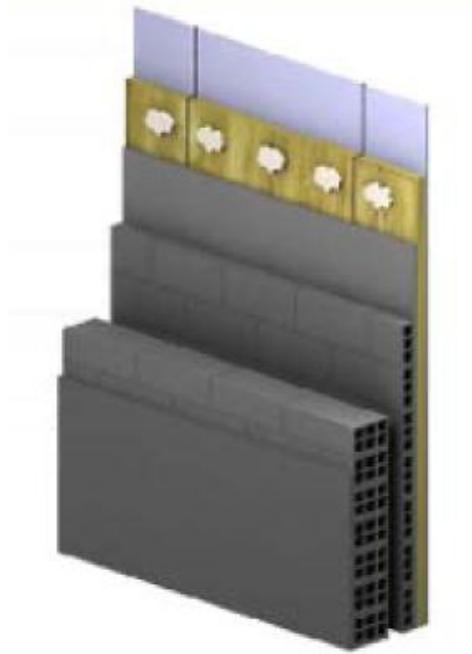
Detalle constructivo de la fachada con aislamiento por el interior (Catálogo de sol. de reh. Del IVE).
